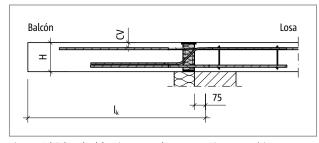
Schöck Isokorb® T tipo K-M13 hasta M14: Sistema estático
